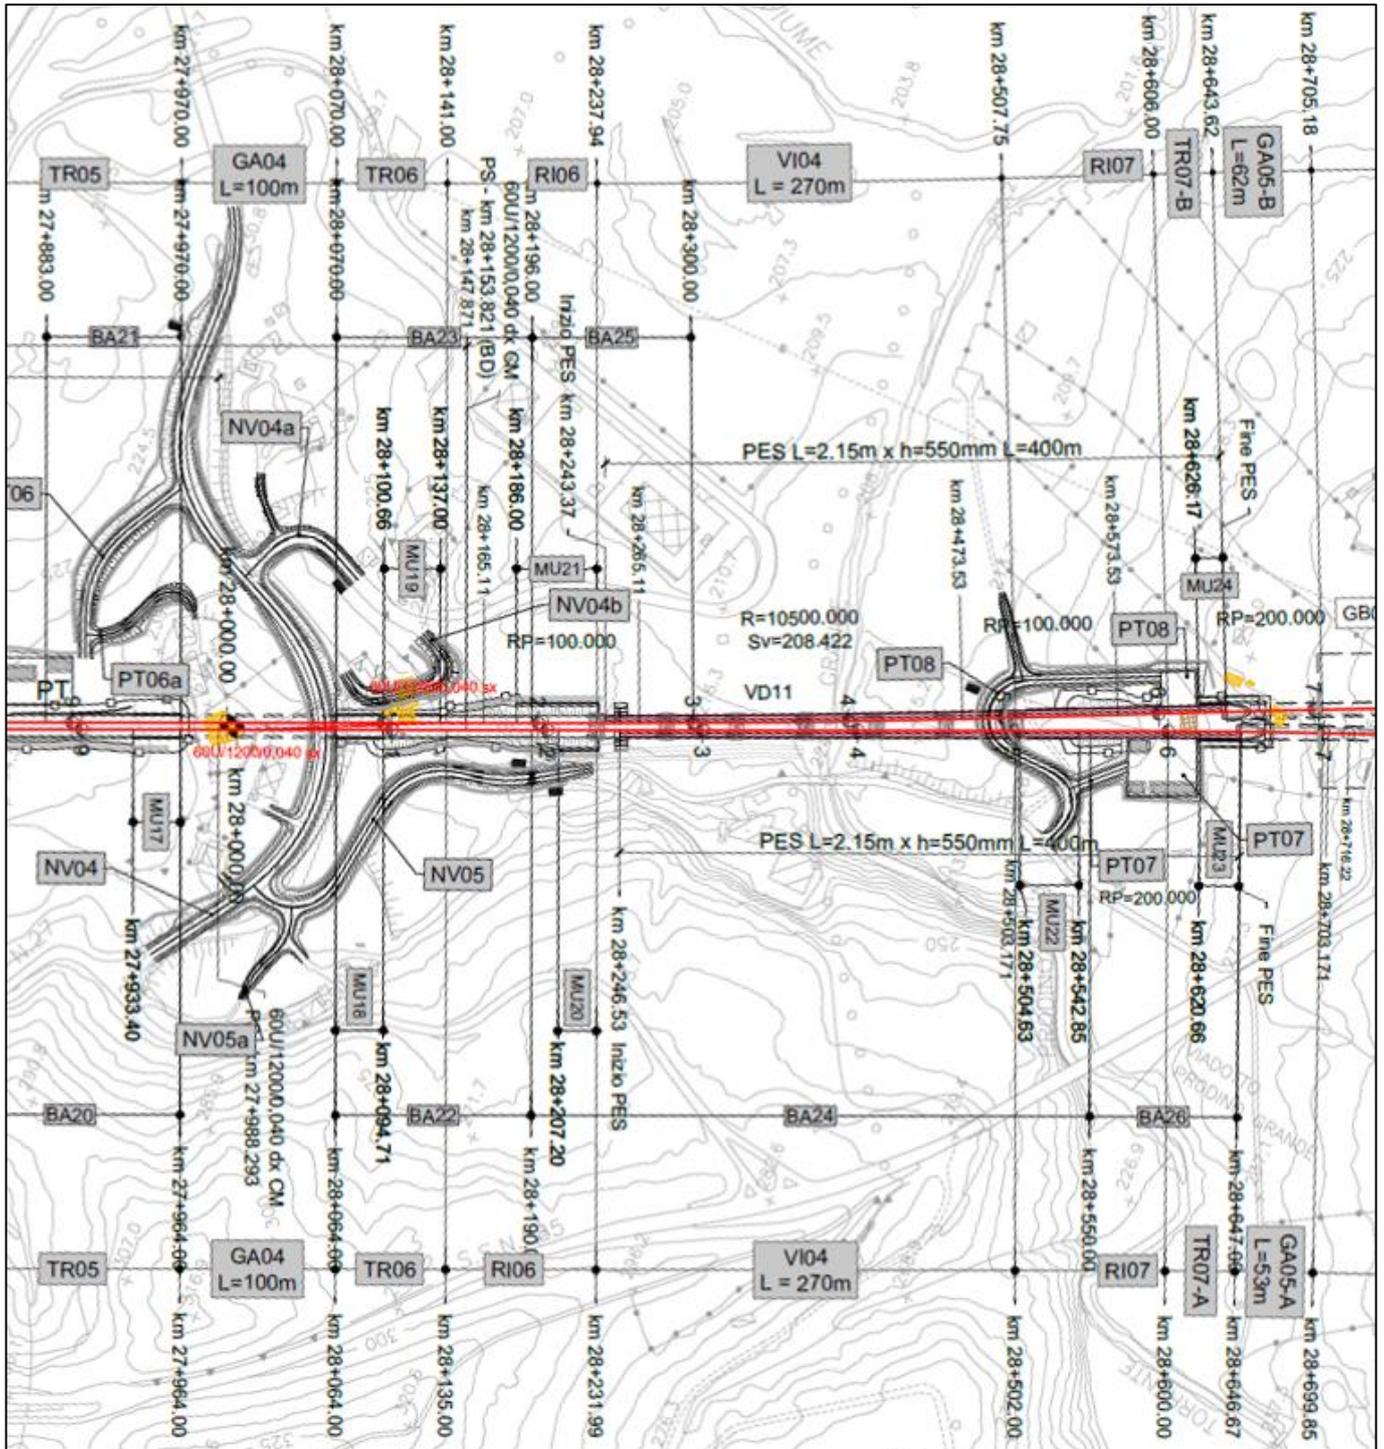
Planimetria di progetto da km 27+964 al km 28+646 BP
